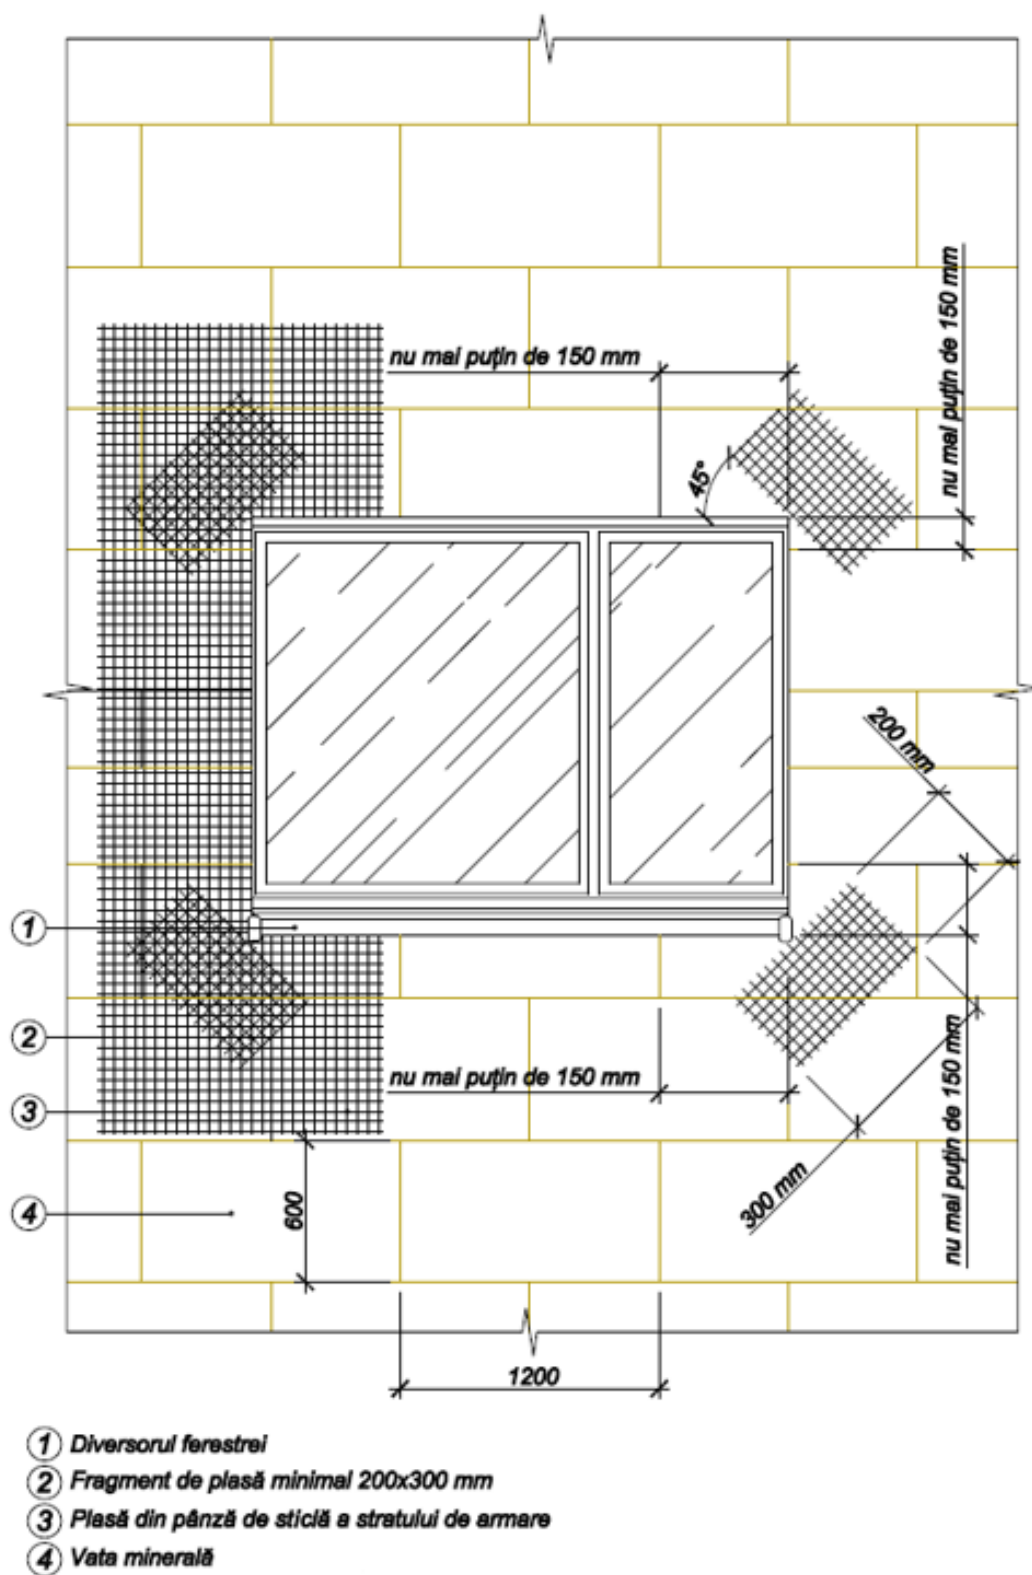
Schema de instalare a elementelor de colț și plasei de armare împrejurul golurilor pentru ferestre
